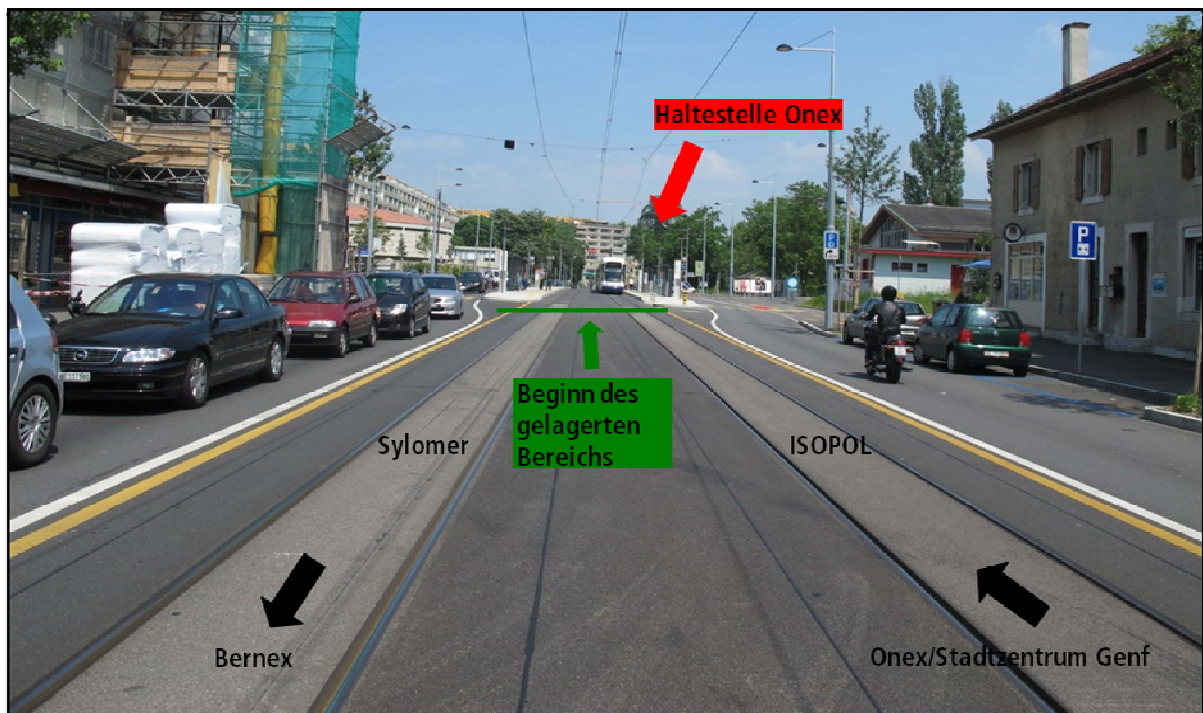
Situation Teststrecke TCOB: Blick in Fahrtrichtung Genf
